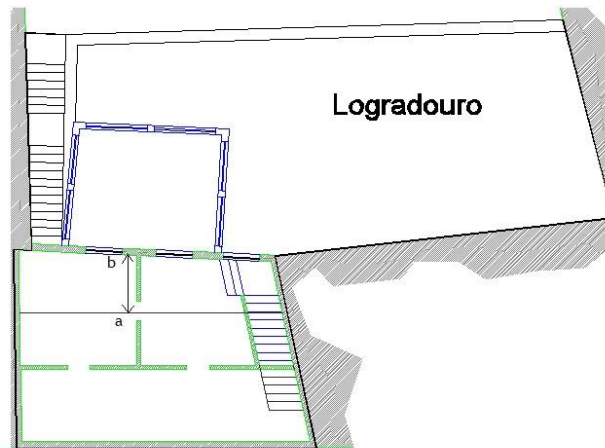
1º andar. Lavandaria Americana (Covilhã)
